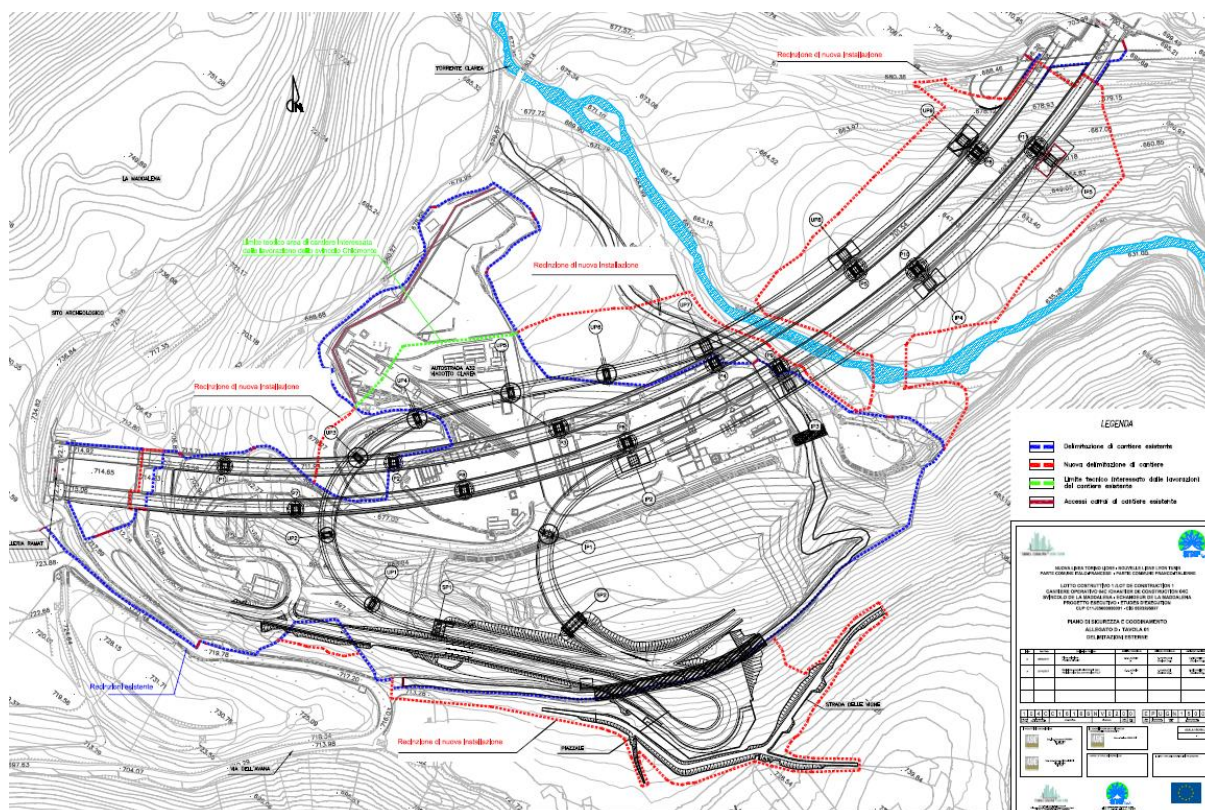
Stralcio planimetrico cantiere La Maddalena con individuazione aree di cantiere
